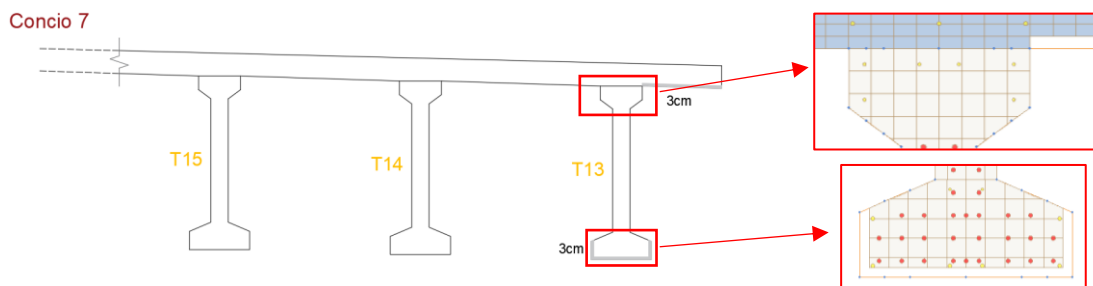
Ponte sul torrente Mavigliano, Caso I_ev1 sezione trasversale Concio 7 + dettagli Midas Civil
